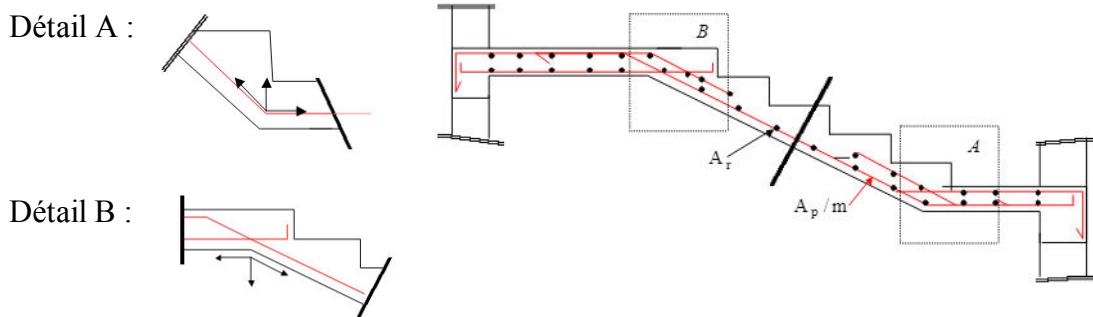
Ferraillage d'un escalier à paillasse à doubles paliers
